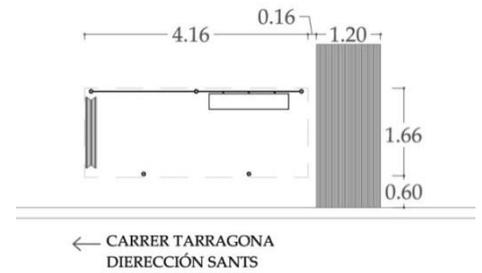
Planta parada 3237 Plaça Espanya. Dibujo de la autora.
